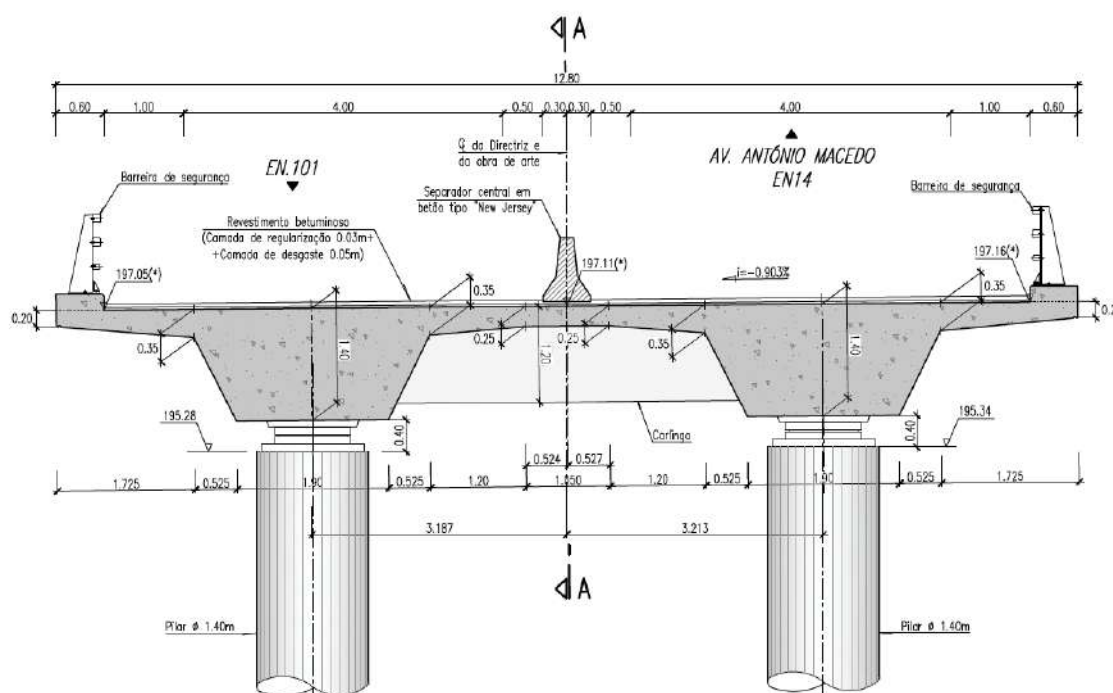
Corte tipo no tabuleiro junto ao apoio (Pilares P1 a P3 e P6).
